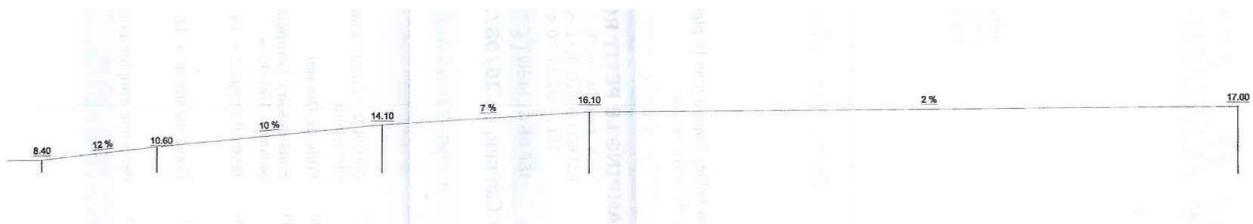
Coupe longitudinale de la voirie (du parking aux HLL 29)
